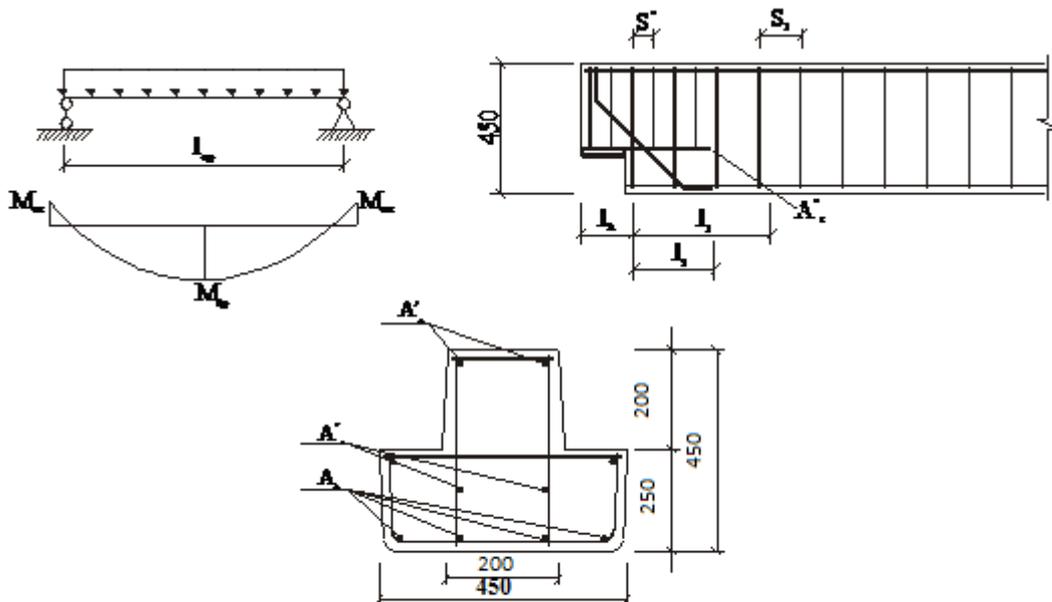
Ригель перекрытия: расчетная схема, схема армирования, поперечное сечение
